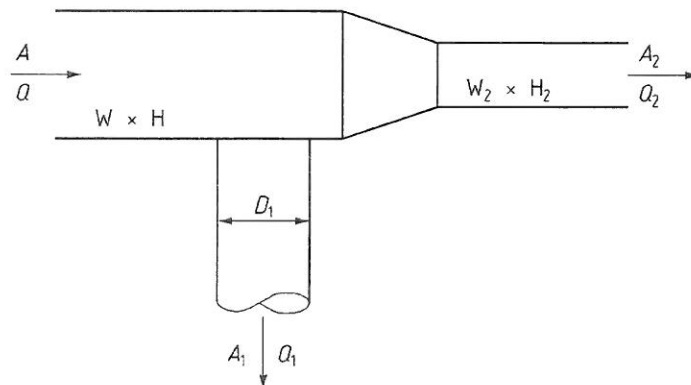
Piquage circulaire sur un conduit rectangulaire
